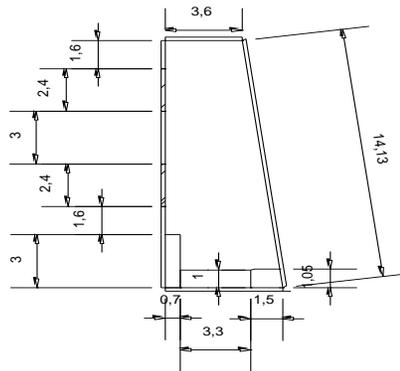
PLANO GARAJE SEDE CALLE 74
